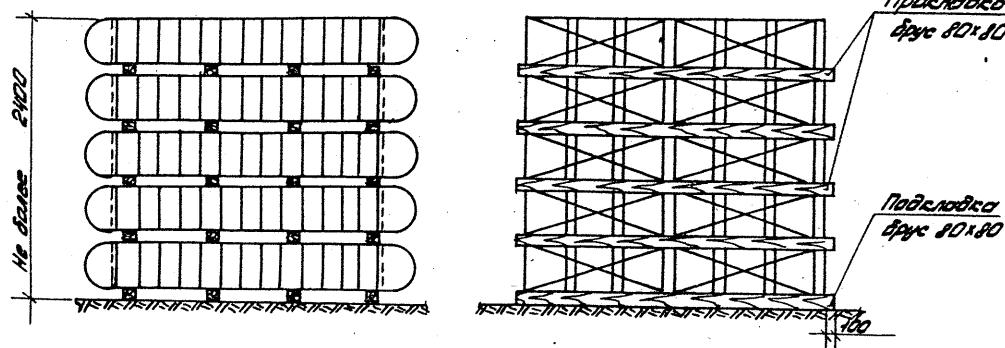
Складирование пространственных армокаркасов перекрытия
